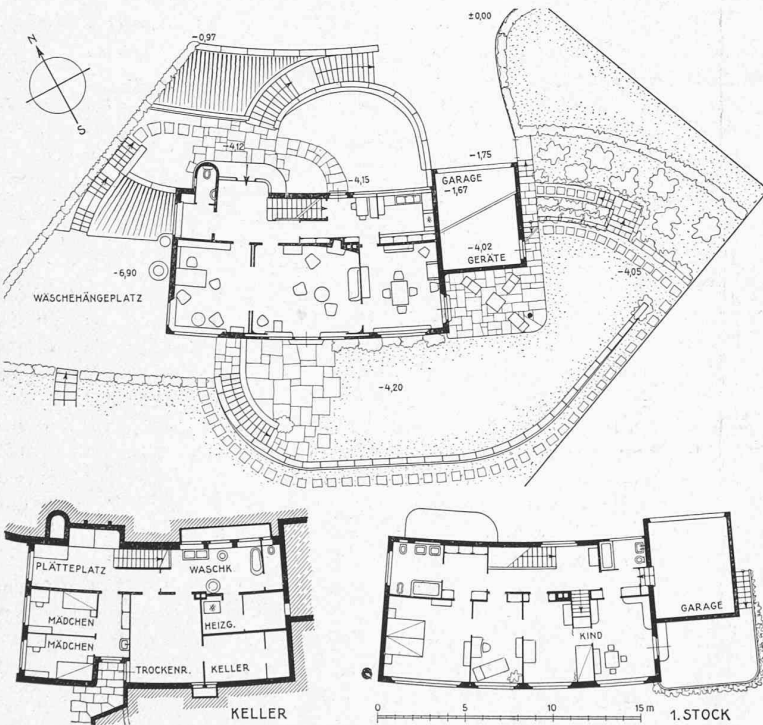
Grundrisse. — Masstab 1 : 400.
